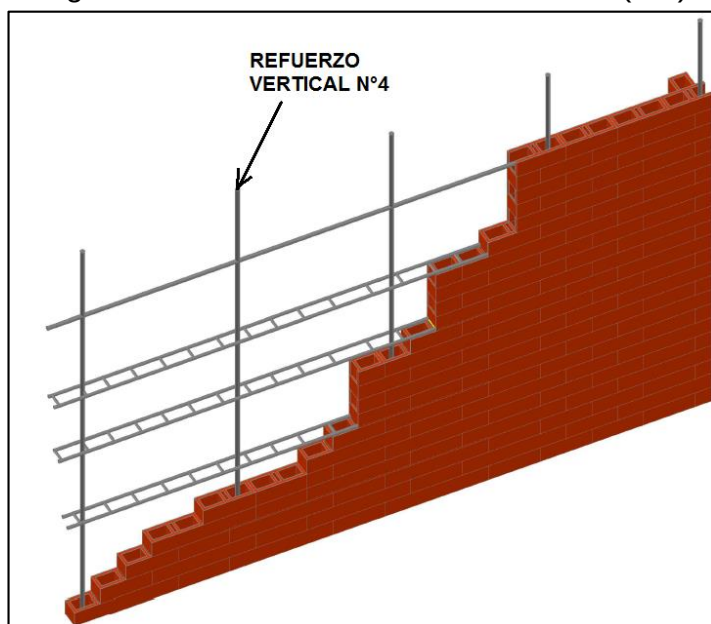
Refuerzo Horizontal muro F (1-4)
